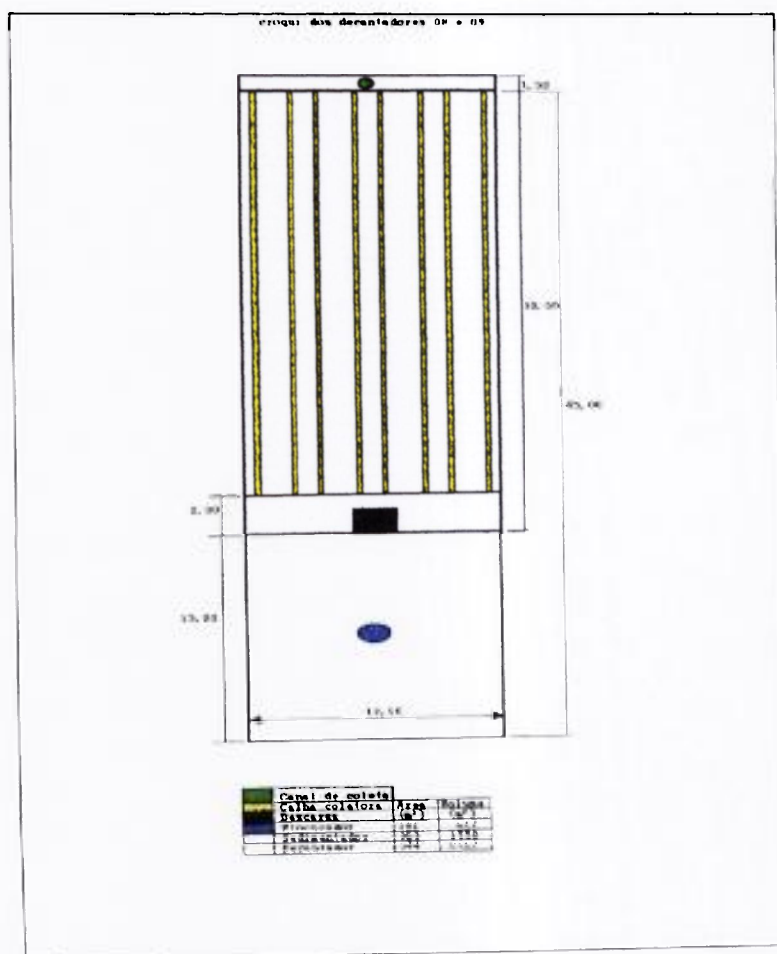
Croqui do decantador 09 (módulo tubular do tipo placas planas paralelas).
